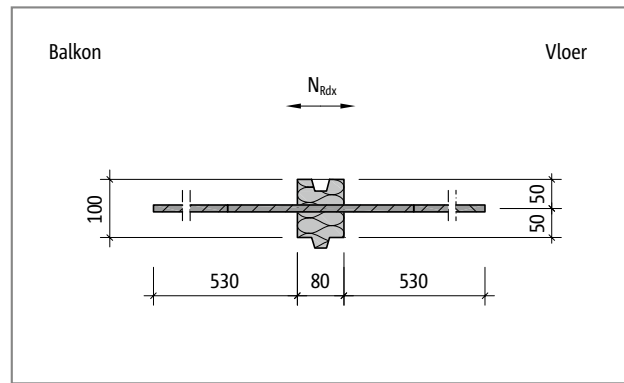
Schöck Isokorb® T type H-NN1: Zijaanzicht
